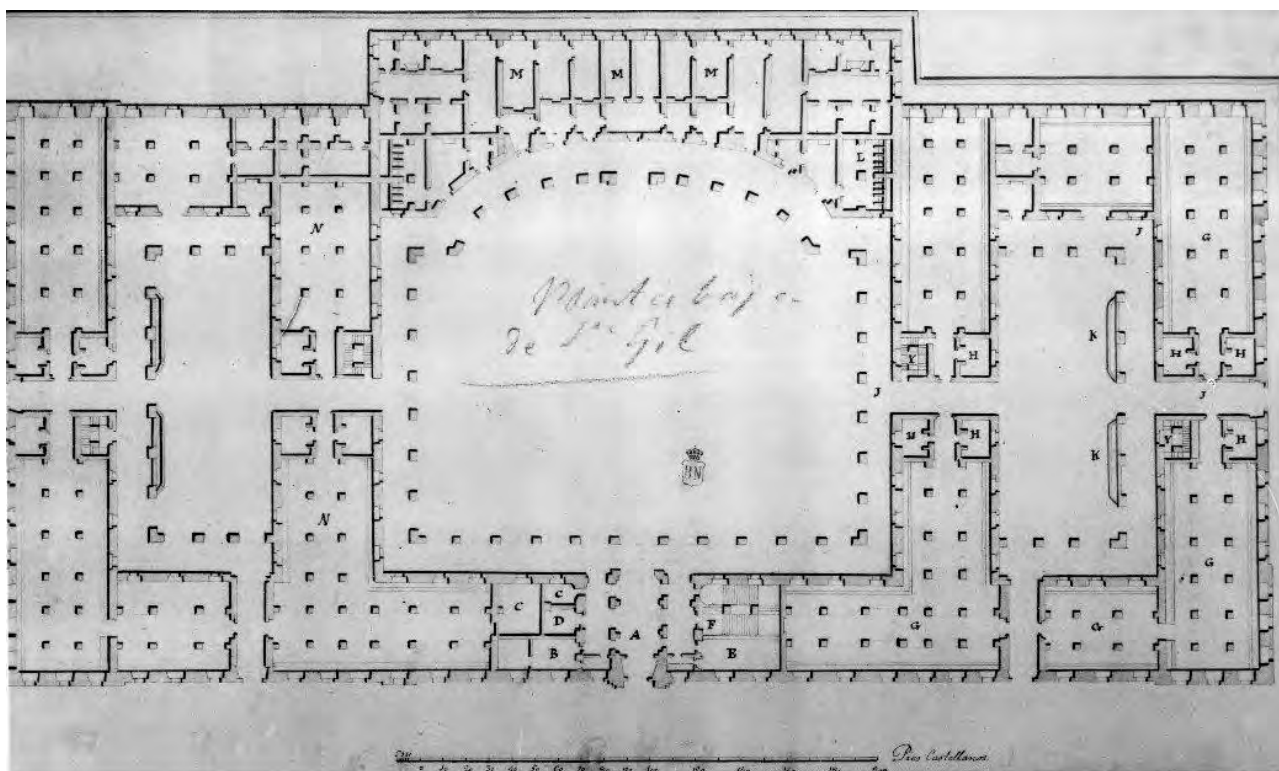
Planta baja del llamado “Cuartel de San Gil”, 1789. Arquitecto: Francisco Sabatini.
